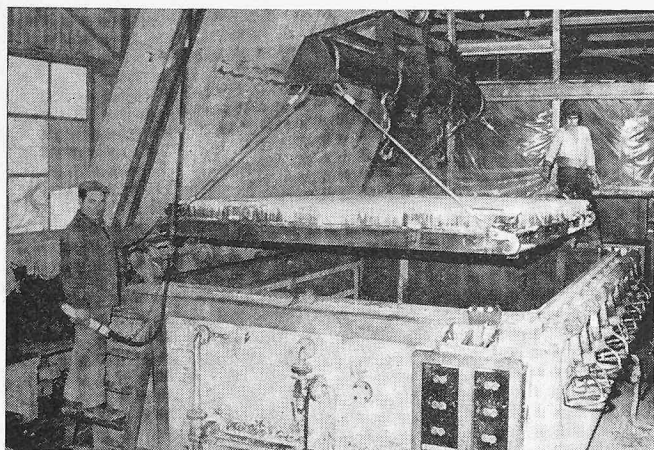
Autoklav für drei Betonplatten. Kapazität 5 Chargen zu drei Platten je Tag (Photo Elementbau System Hegetschweiler)
